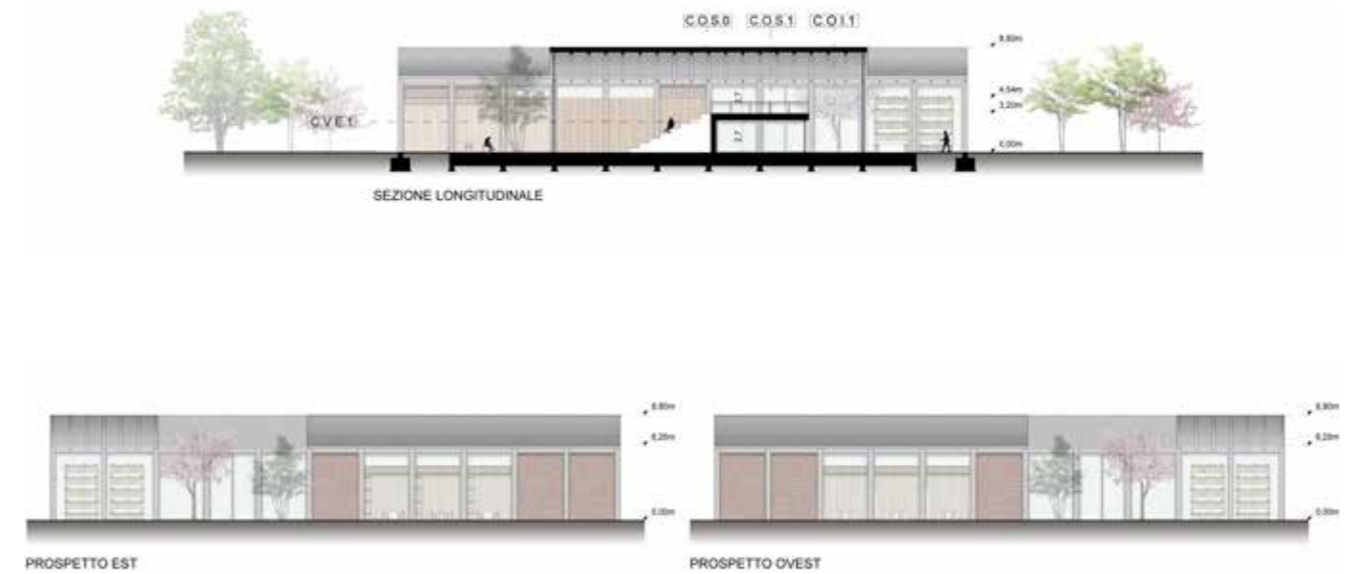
Sezione longitudinale e prospetti Capannone "O"
